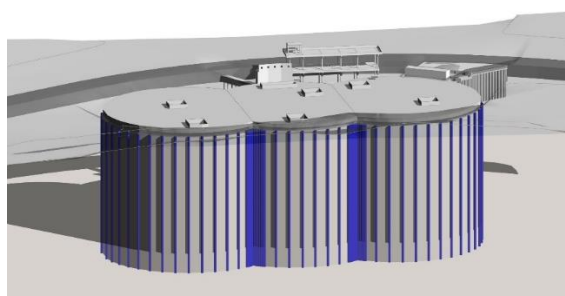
Integração dos modelos BIM das diversas estruturas e infraestruturas adjacentes.
